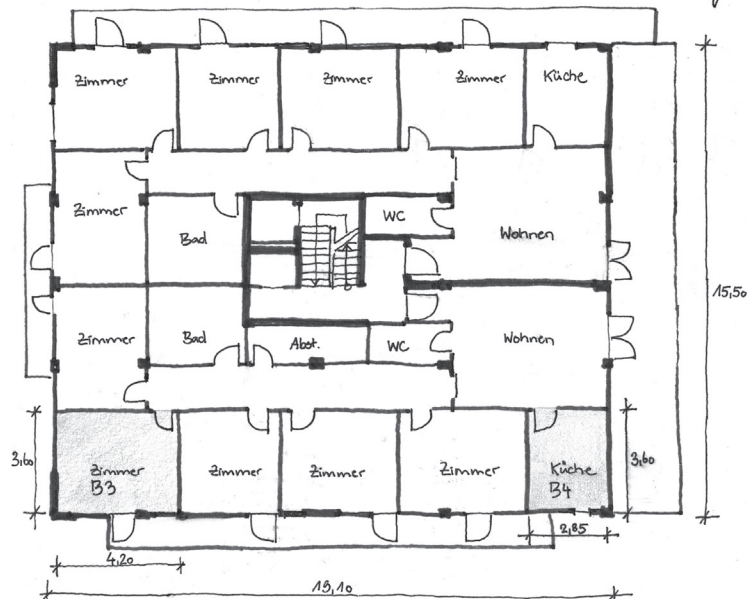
Beispielgebäude B, Grundriss 6. Geschoss
